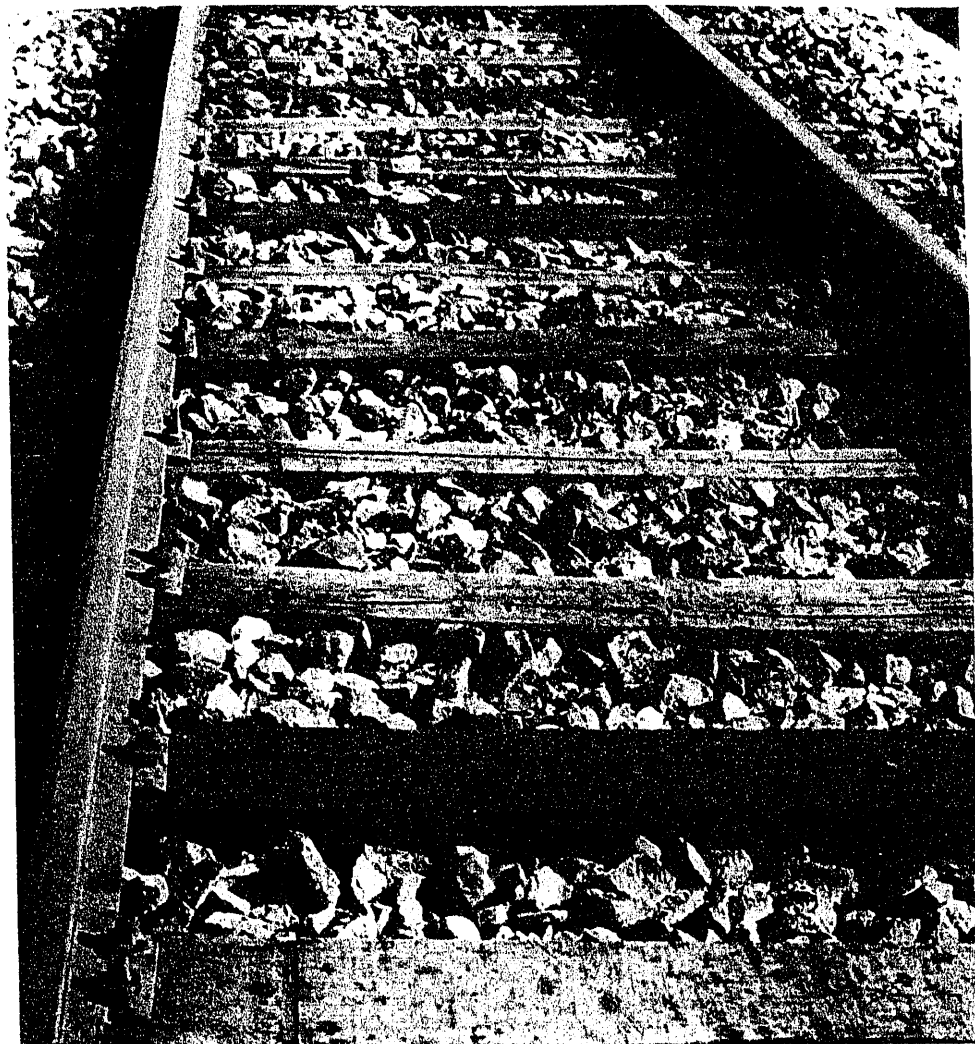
^a — Traviesas de madera puestas nuevamente en la vía después de un descarrilamiento (RENFE).
